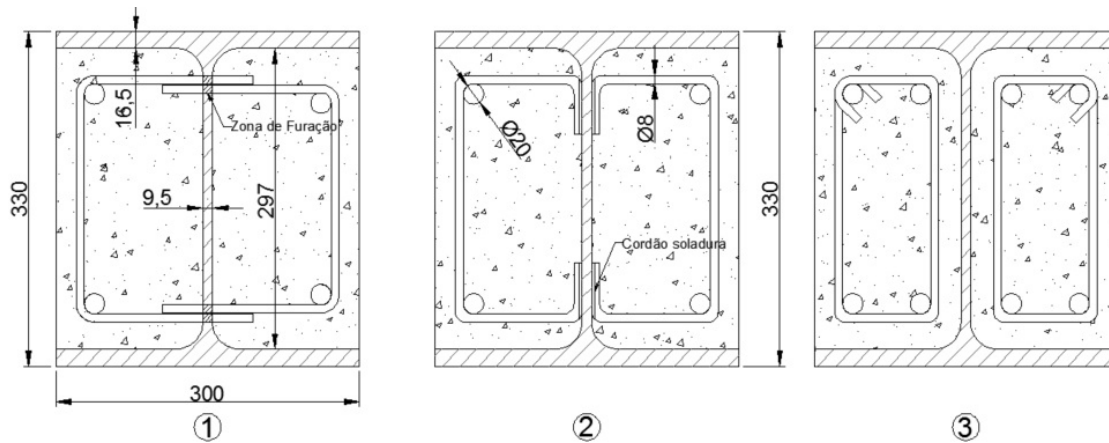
Disposições de estribos em secções parcialmente revestidas de betão: (1) Disposição de estribos atravessando a alma do perfil de aço; (2) Disposição de estribos soldados à alma do perfil de aço; (3) Disposição de estribos fechados.
